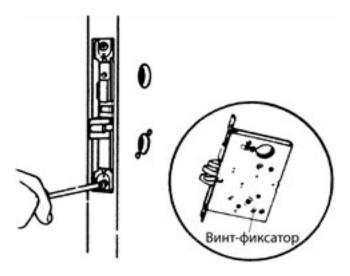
Установка корпуса замка (С разрешения компании Schlage Lock Company)
